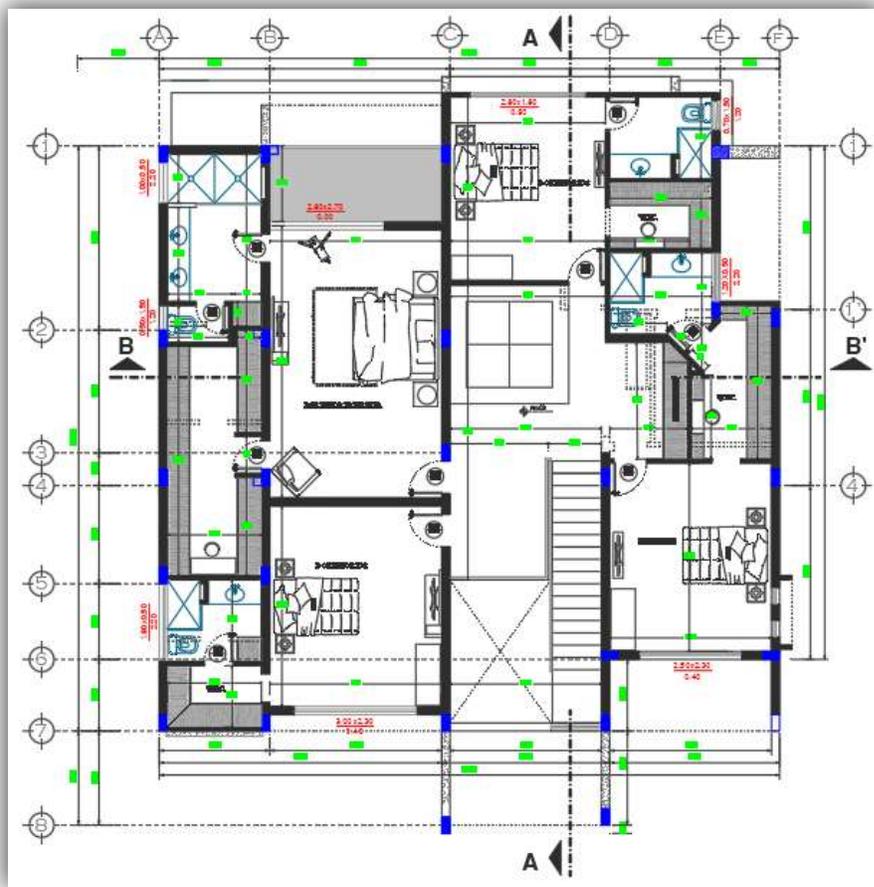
Dimensiones del terreno, Vista en planta Residencia Familiar, Planta Alta
